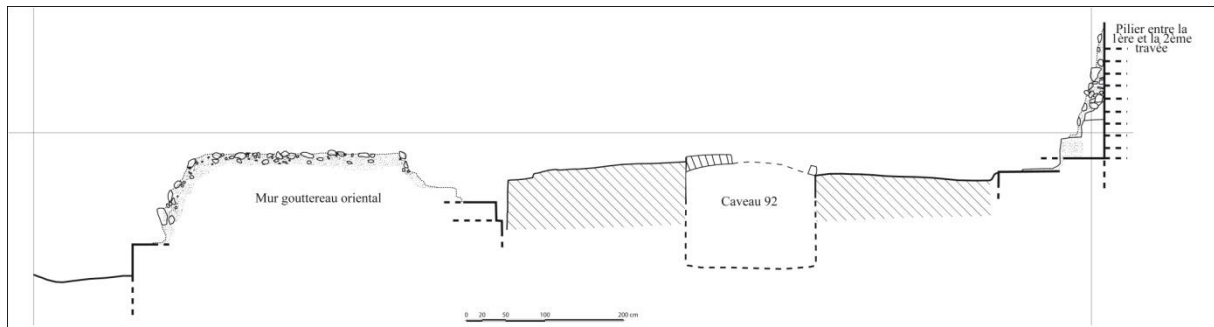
Coupe de la nef de l'église : le caveau est parfaitement centrée (relevé : équipe de fouille ; D.A.O. : M. Varano).
